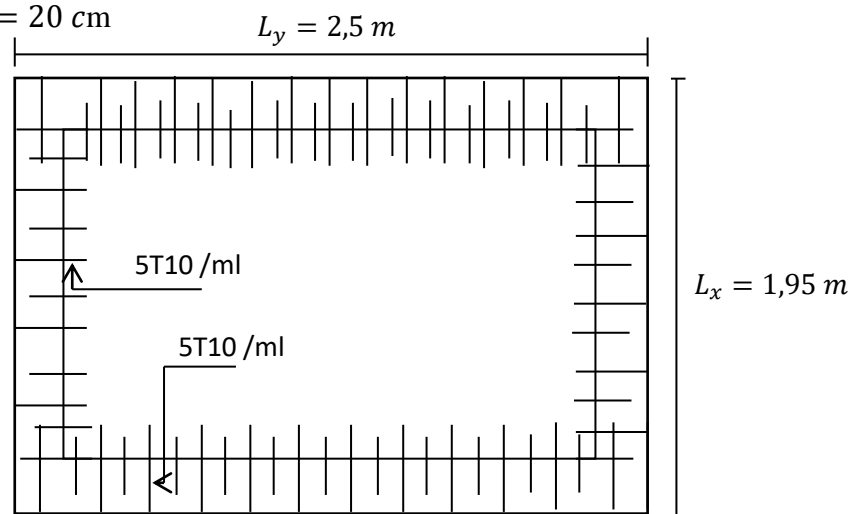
Ferrailage supérieur de la dalle de l'ascenseur
